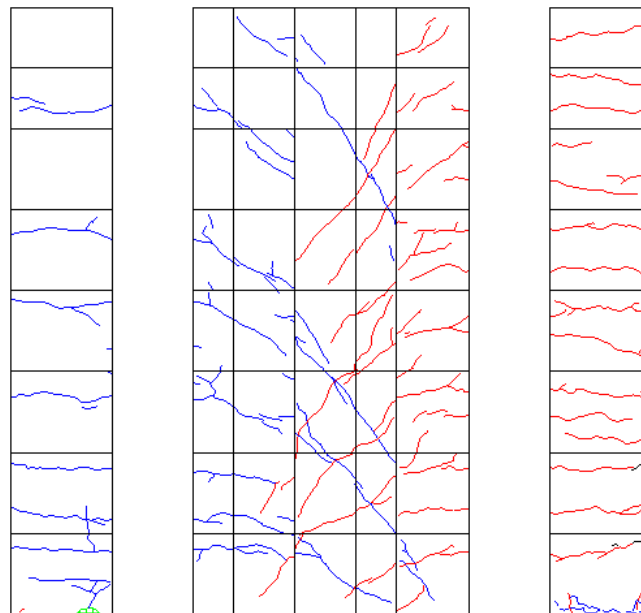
R=1/67 ひび割れ図
